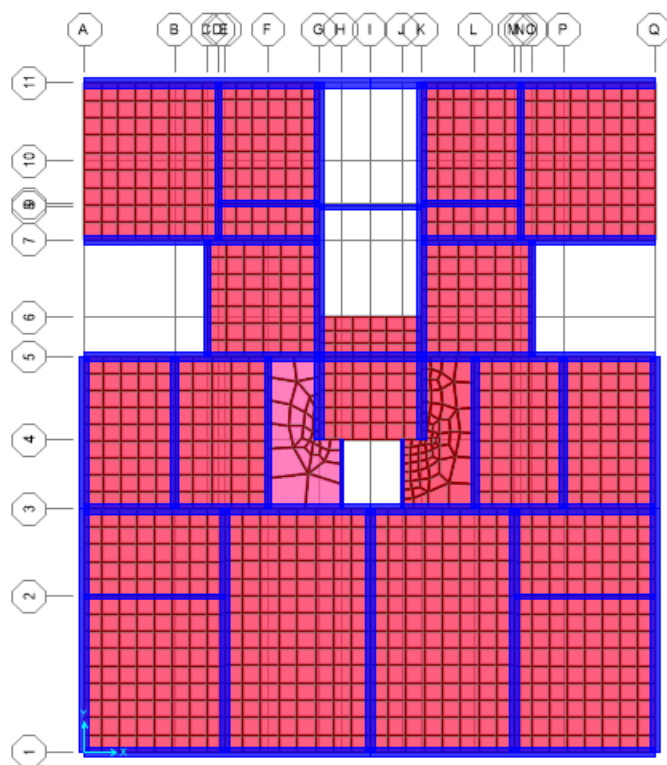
Vista en planta del modelamiento. Fuente propia
